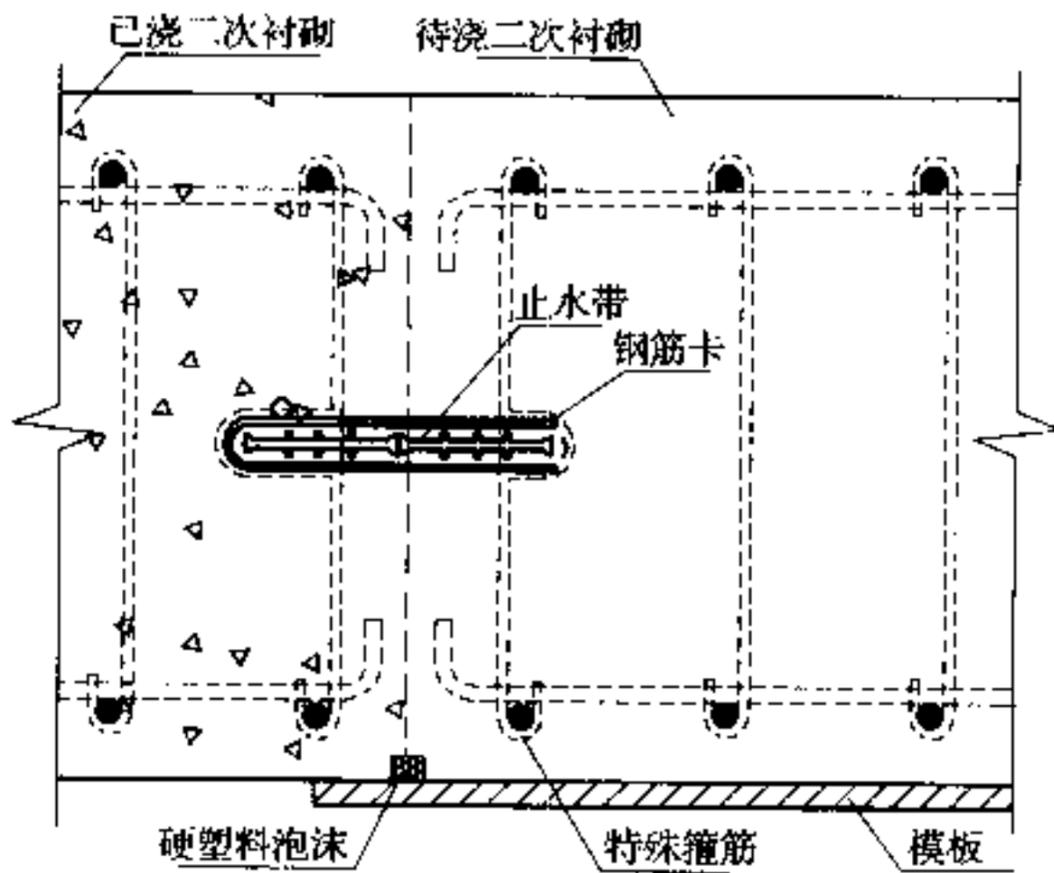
3 在钢筋混凝土中固定中埋式止水带
